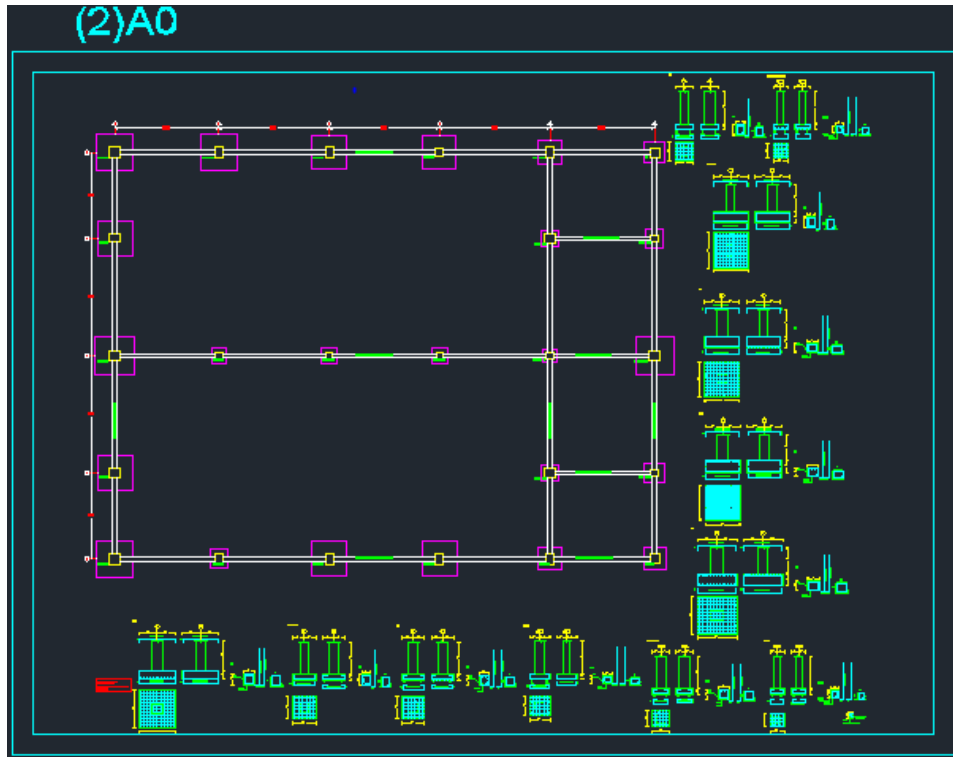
Planta arquitectonica. Detalle de Zapatas, Pedestales y viga de amarre. Fuente Codesarrollo
